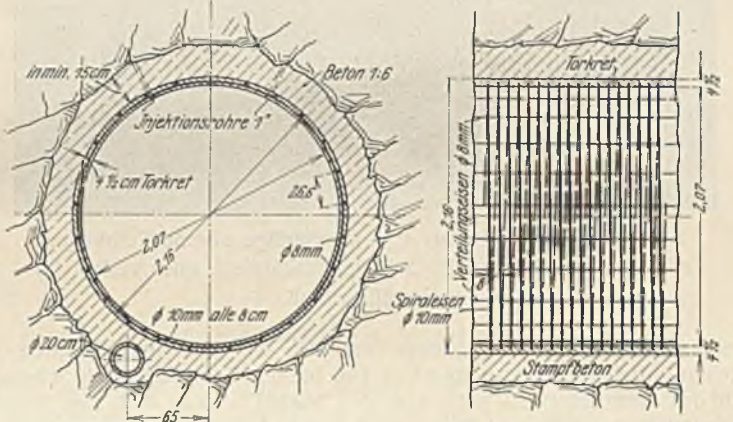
Normalprofil der auf 1,5 at bewehrten Stollenstrecken.
